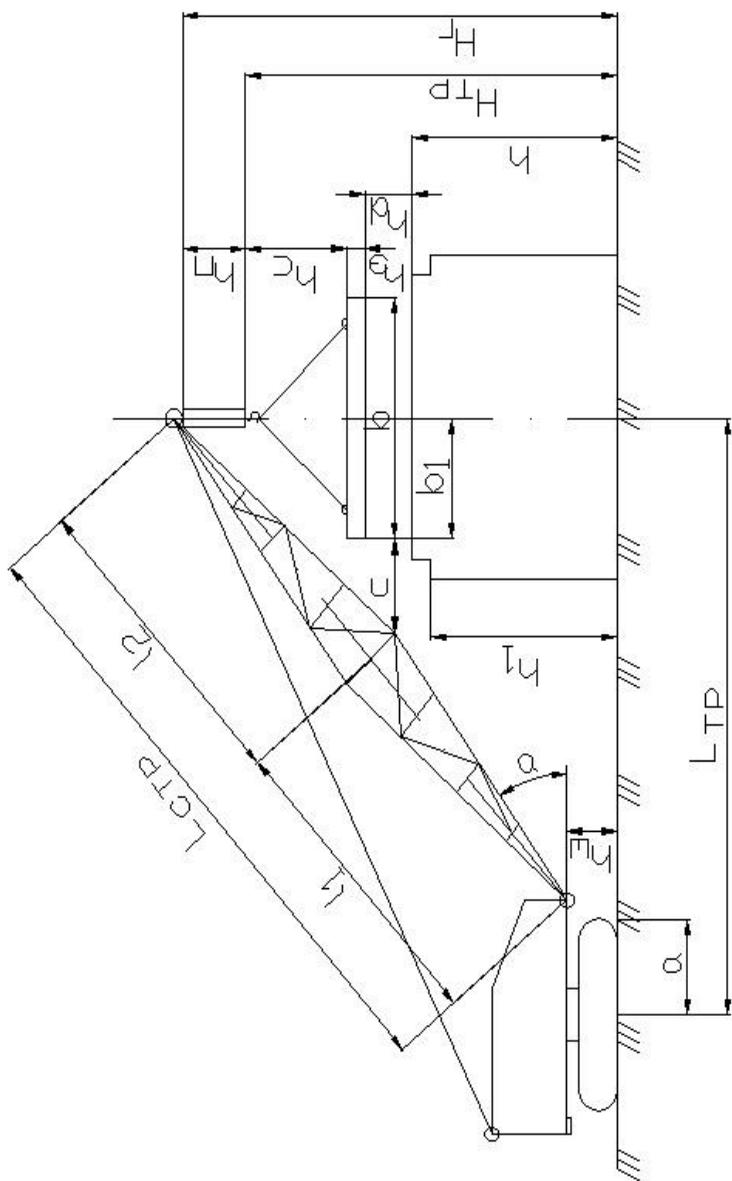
Схема монтажа конструкций с переносом их через ранее смонтированные конструкции
